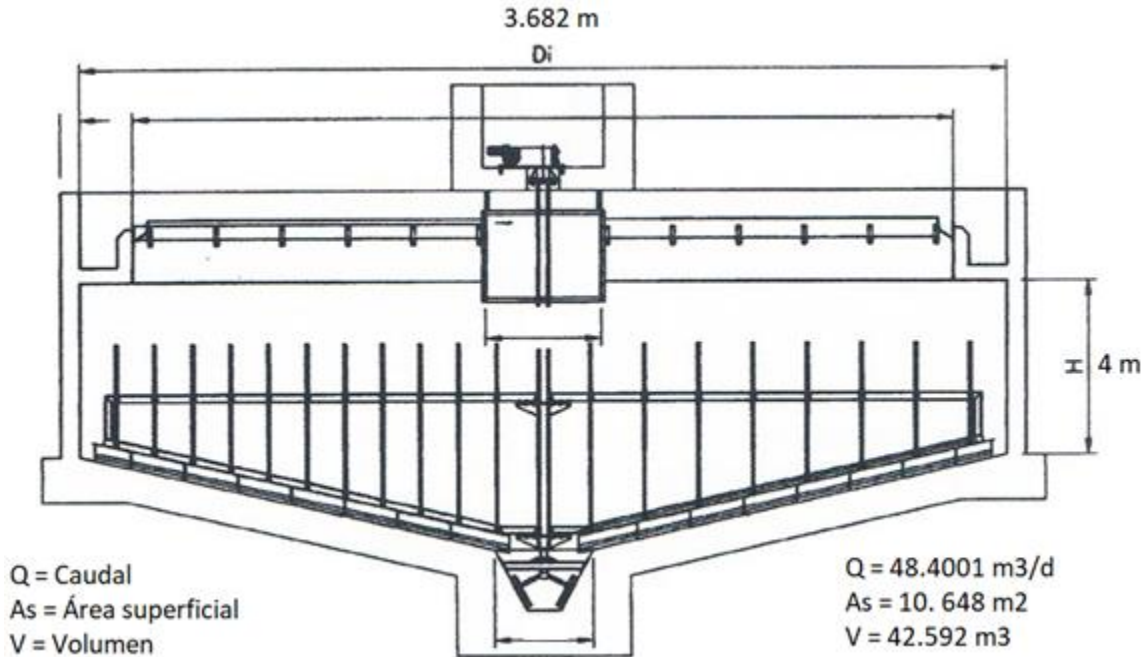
Plano del espesador por gravedad de la planta de 40 L/s. (Elaboración propia).
